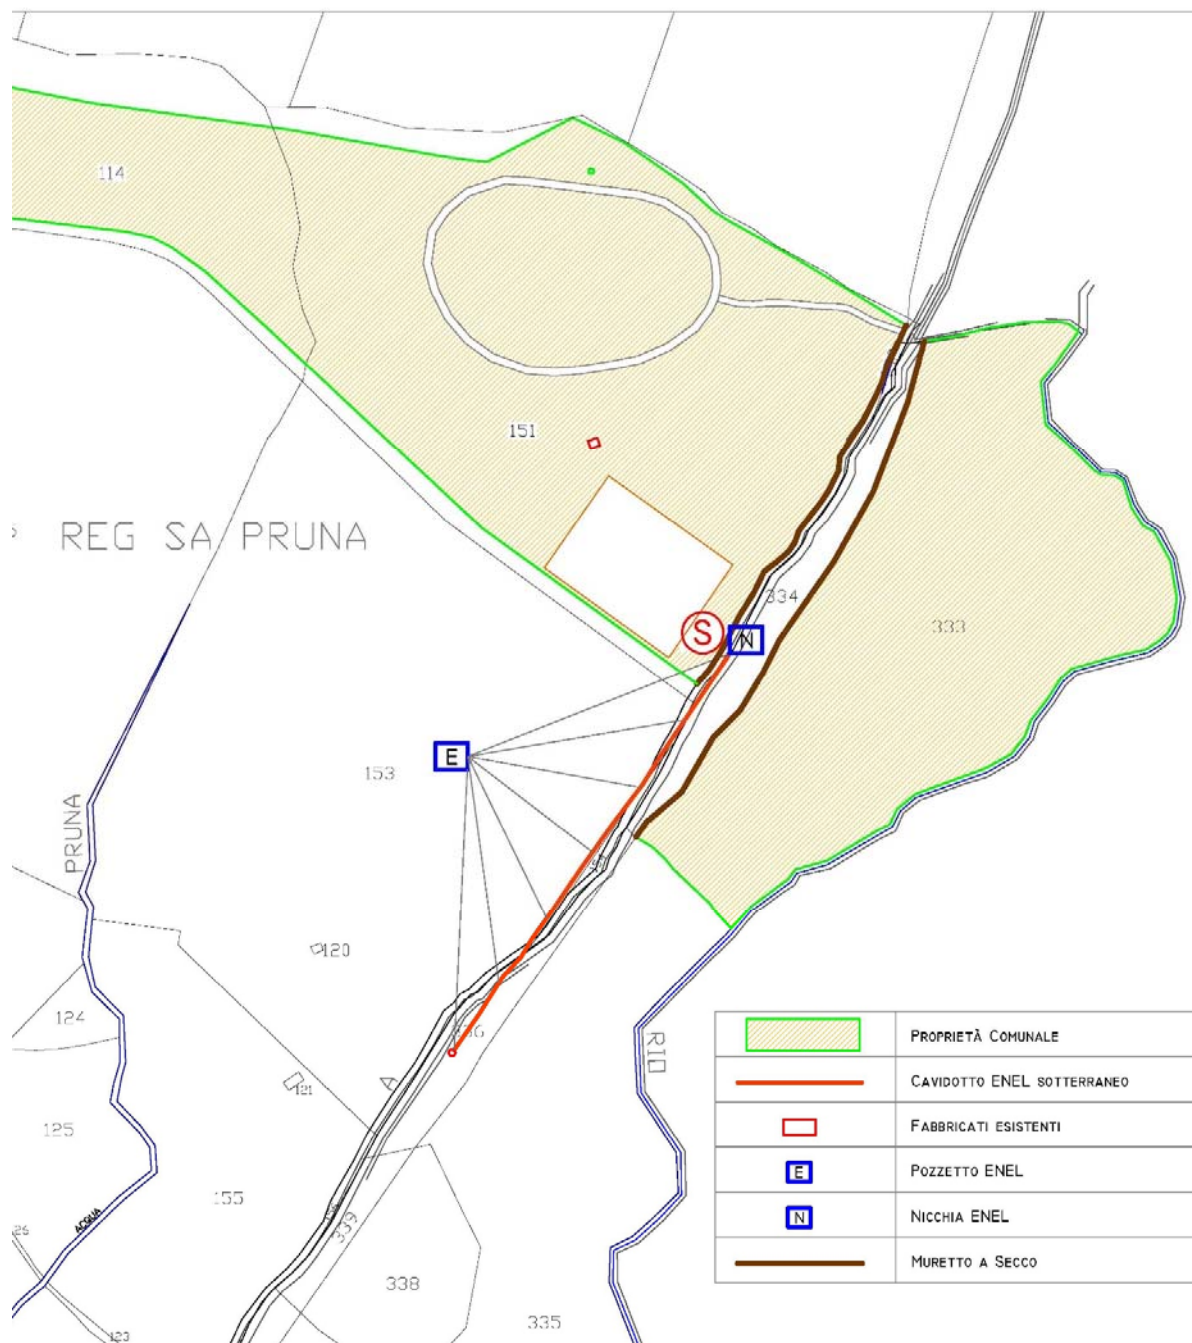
Planimetria catastale interventi previsti per linea elettrica - 1° Lotto
